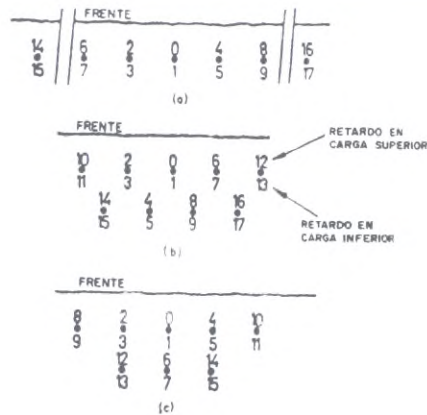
Disparo con cargas secuenciadas dentro de los barrenos.
